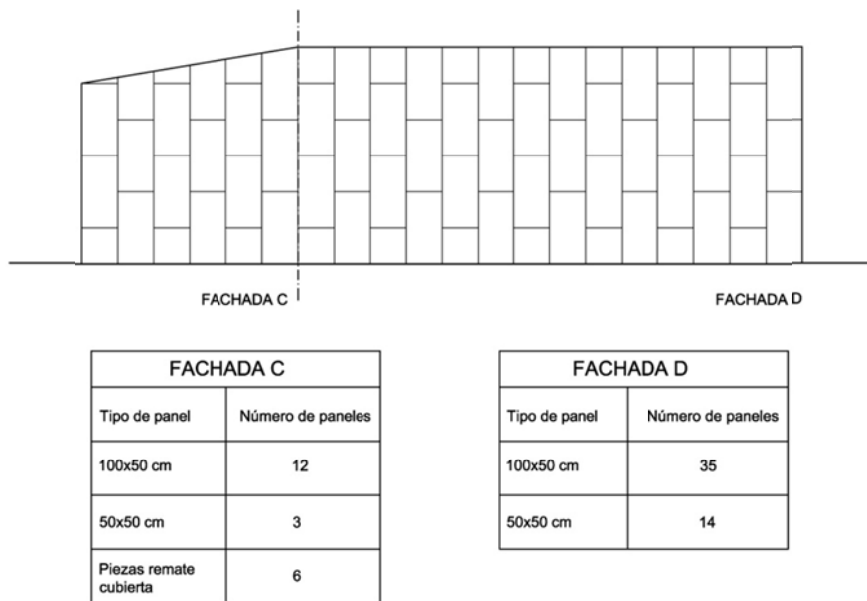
Esquema de reparto de paneles en fachada. (Fuente: Elaboración propia).
